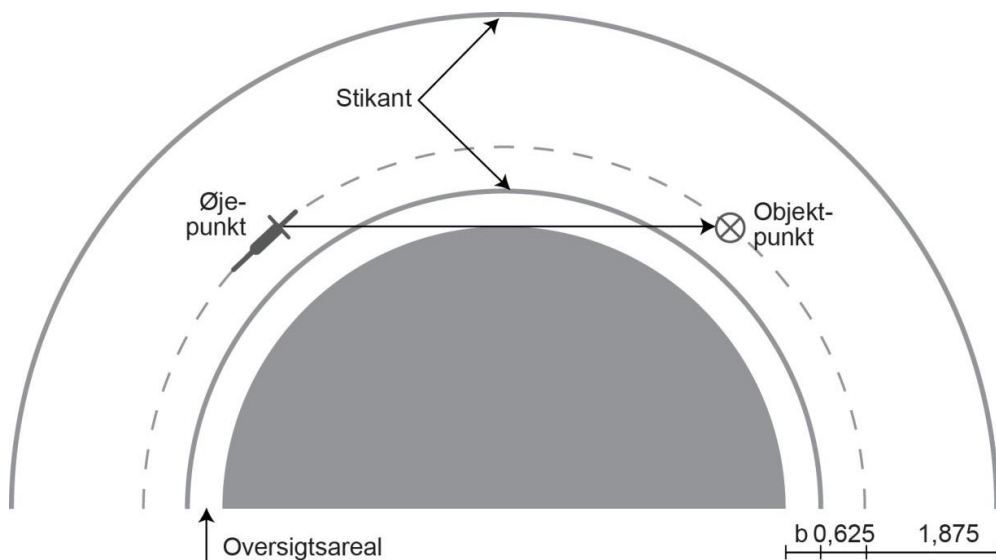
Mindste horisontalradier baseret på stopsigt.
